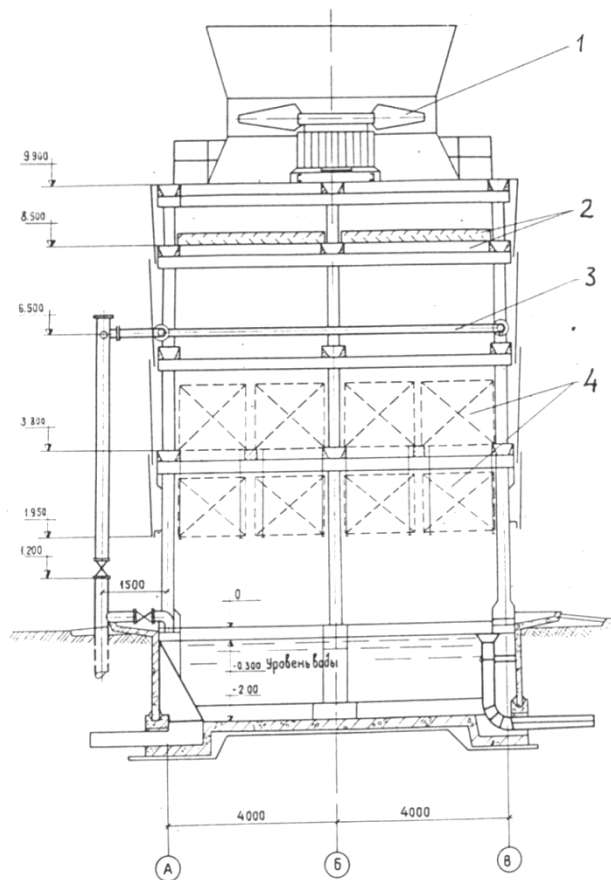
Секция вентиляторной градирни (площадь 64 м<sup>2</sup>):
